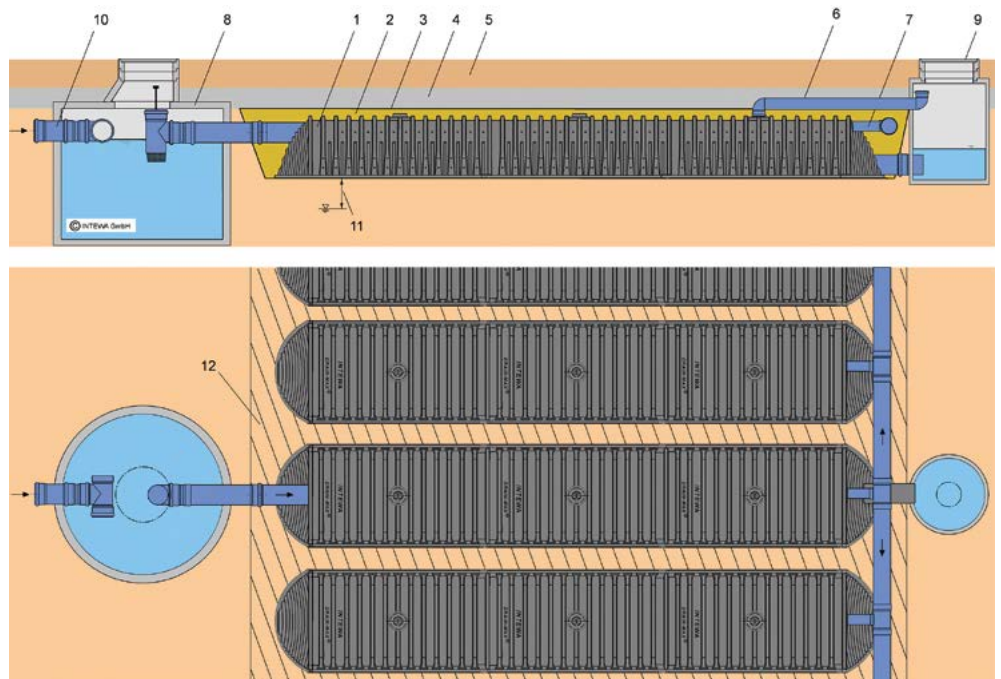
• Aufbau eines Regenwasser-Rückhaltesystems mit DRAINMAX Tunneln und INTEWA Connect-Technologie.
